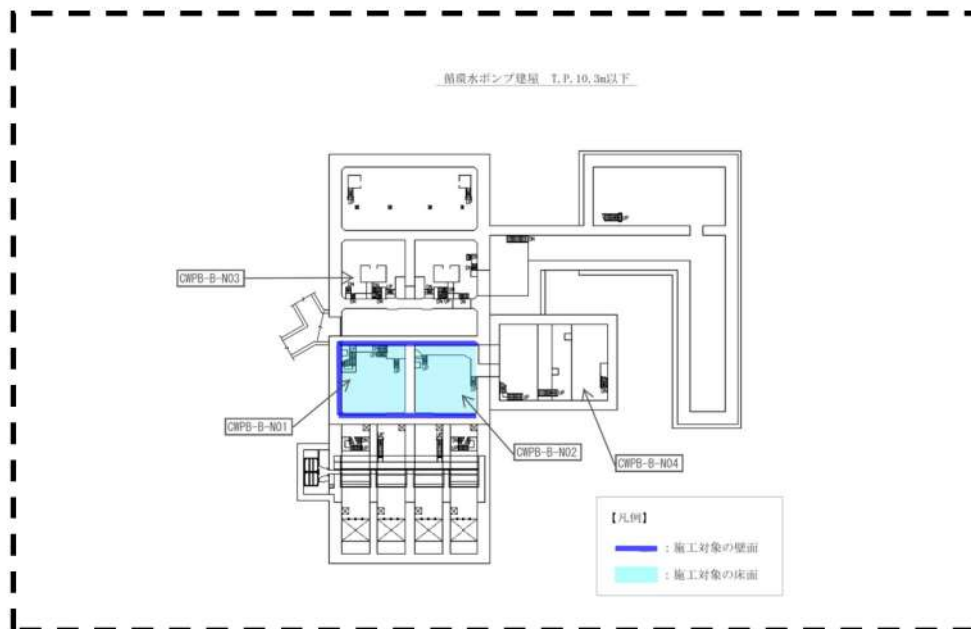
溢水防護対策施工対象の壁及び床の配置図 (11/11)
